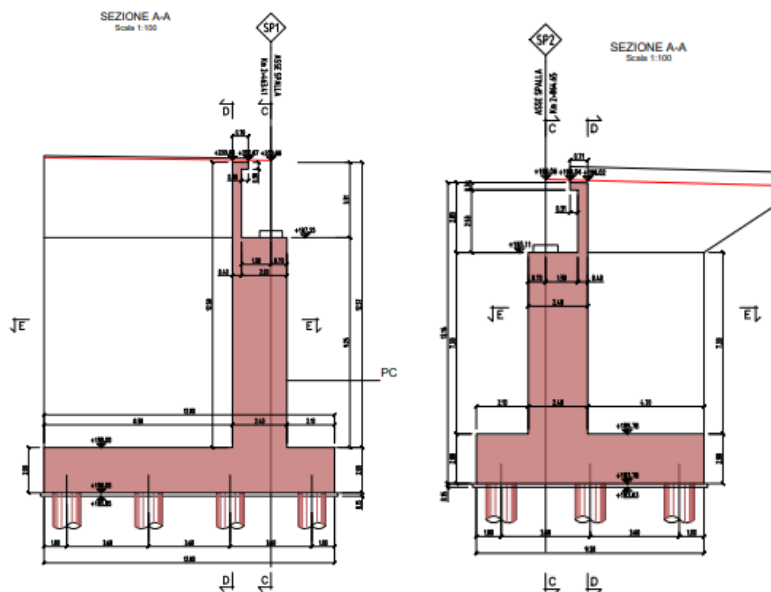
Sezione trasversale spalla 1 e 2
